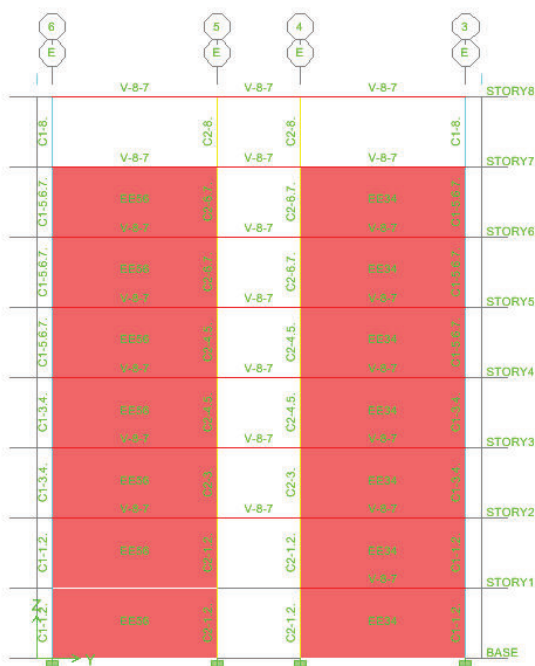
PÓRTICO EJE 3 INDICANDO ELEMENTOS “PIER” BLOQUE B
